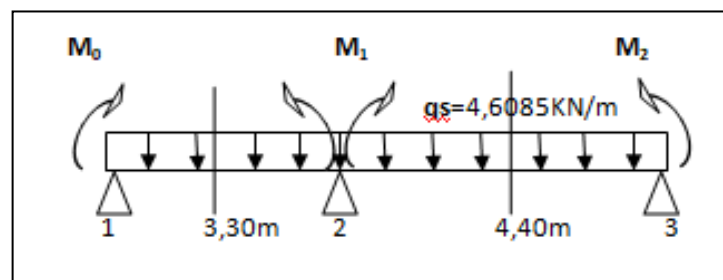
schéma statique de la poutrelle type 1 à l'ELS
